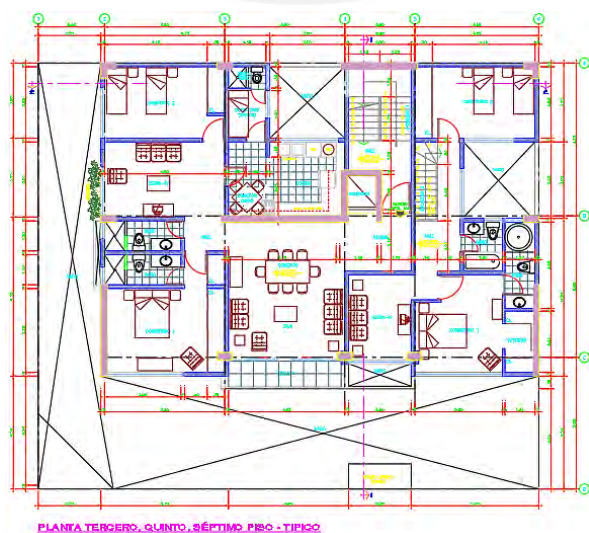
Planta arquitectónica típica de los pisos impares, salvo el primero.
